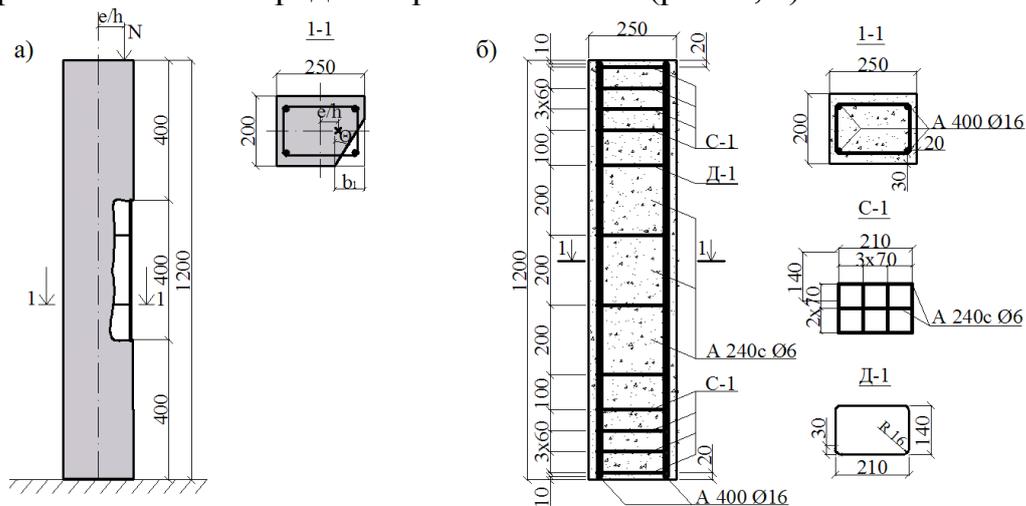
Опытный образец: а – общий вид поврежденного элемента; б – схема армирования
